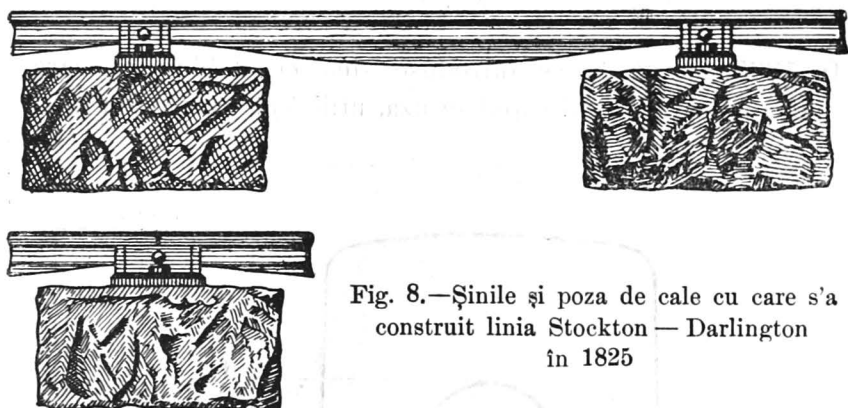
Şinile şi poza de cale cu care s'a construit linia Stockton — Darlington în 1825
